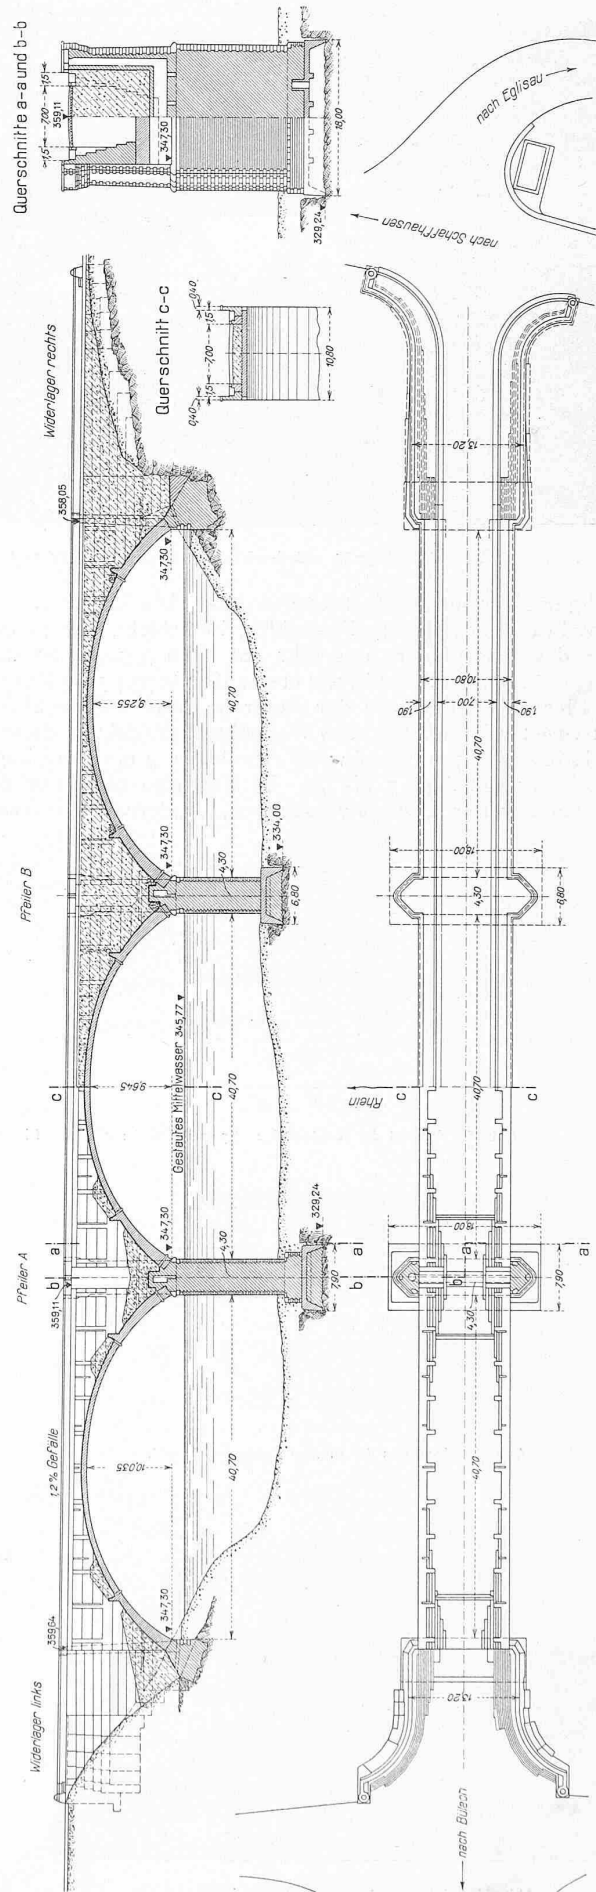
bis 3. Längsschnitt (vor und nach Auffüllung), Draufsichten und Querschnitte der neuen Strassenbrücke über den Rhein bei Eglisau. — Masstab 1 : 800.
